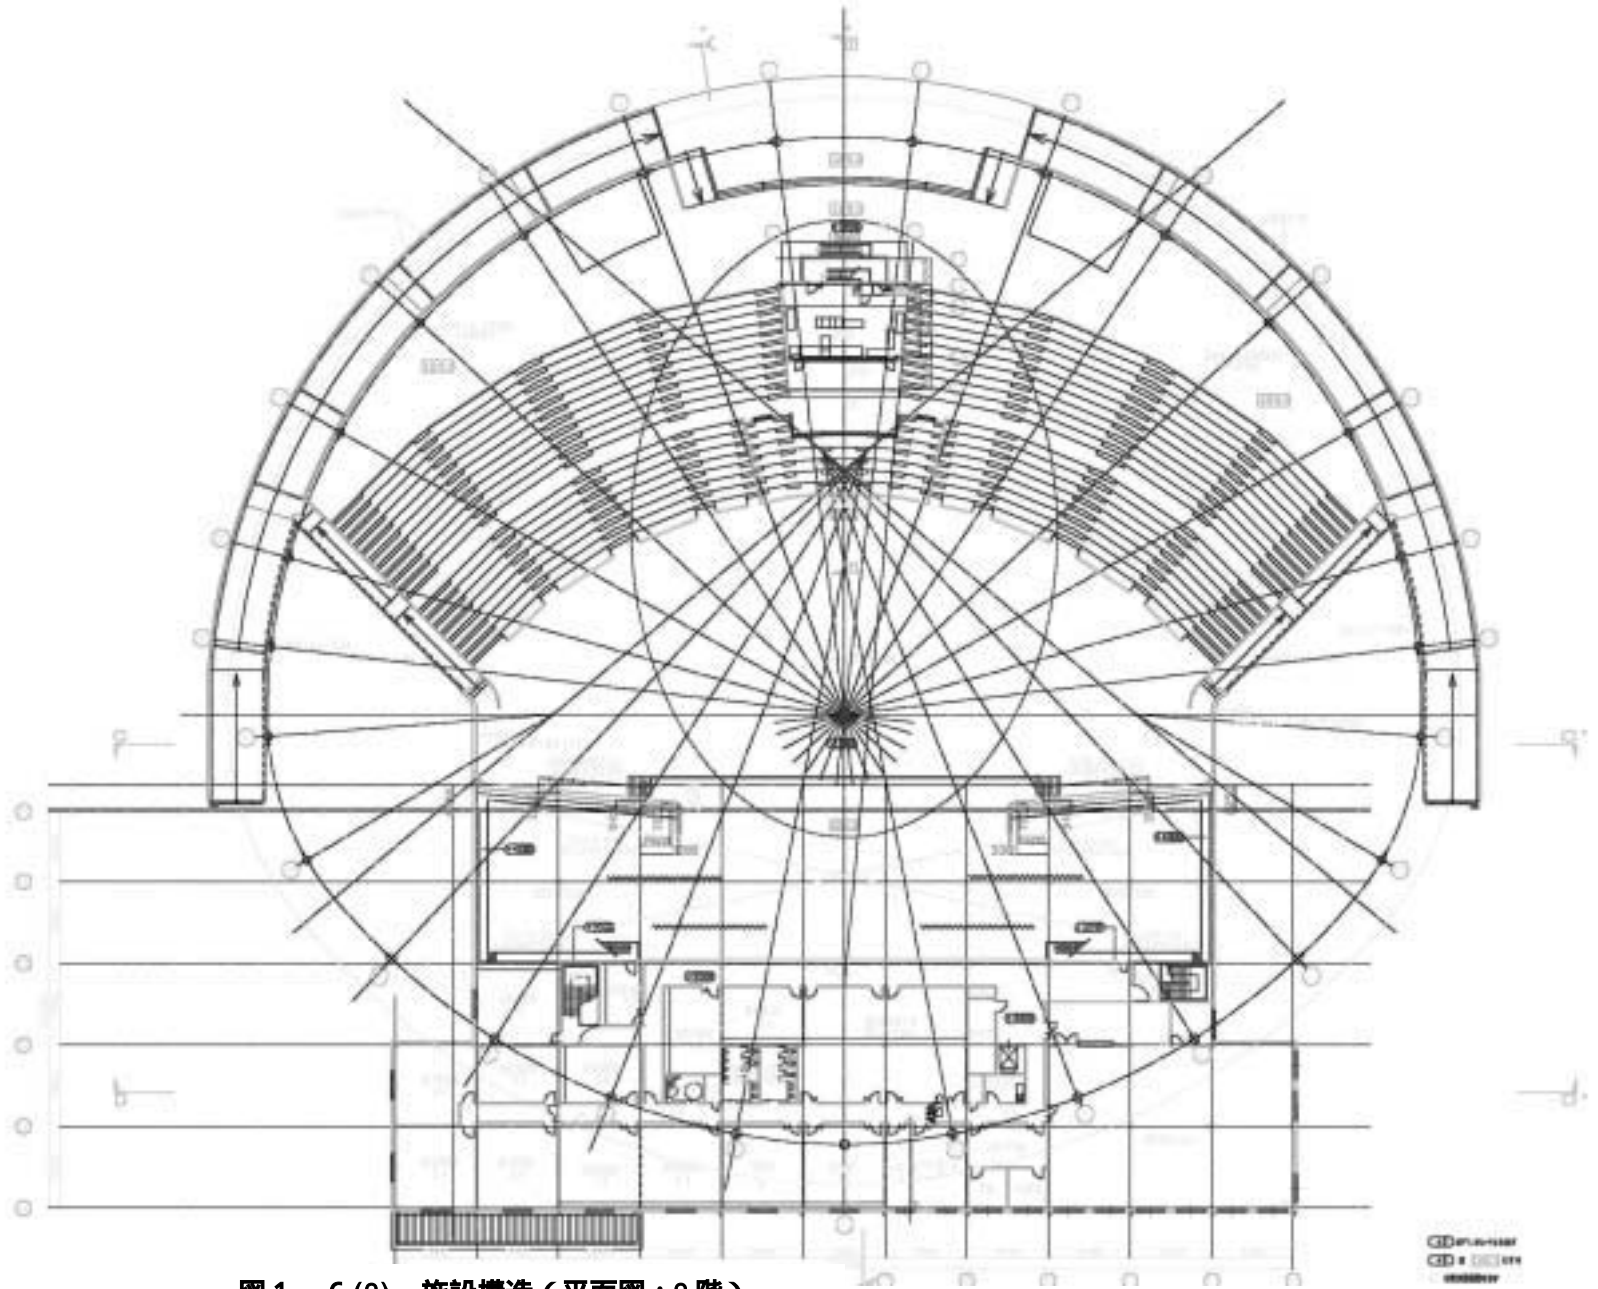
6 (2) 施設構造 (平面図 : 2 階)
